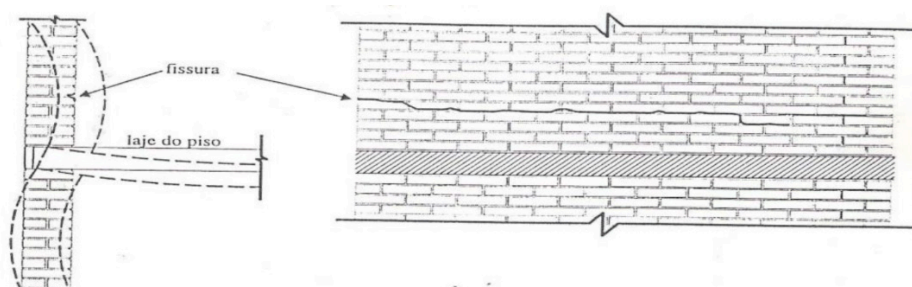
Configuração das trincas na alvenaria devido a deformação excessiva da laje. (Silva e Jonov)
